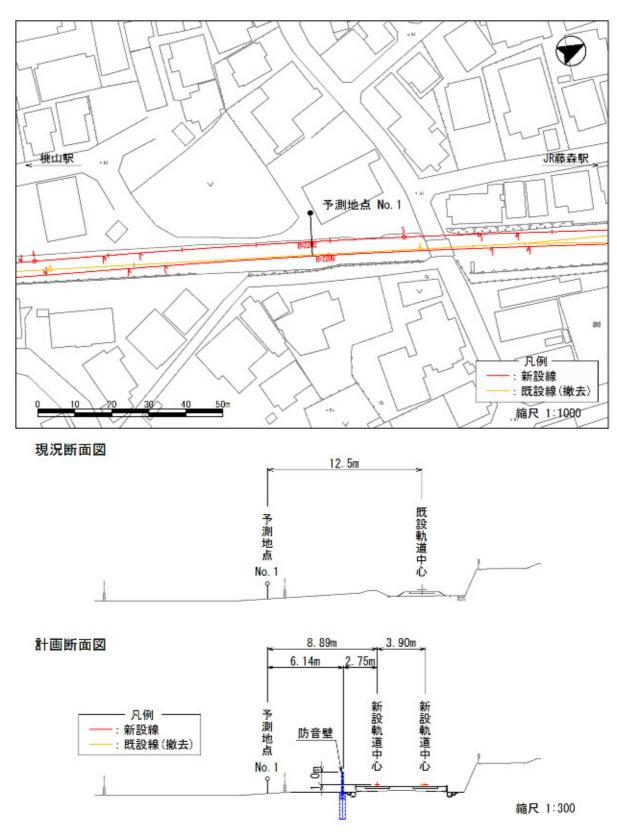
(1) 予測平面·断面図(予測地点 No. 1)
